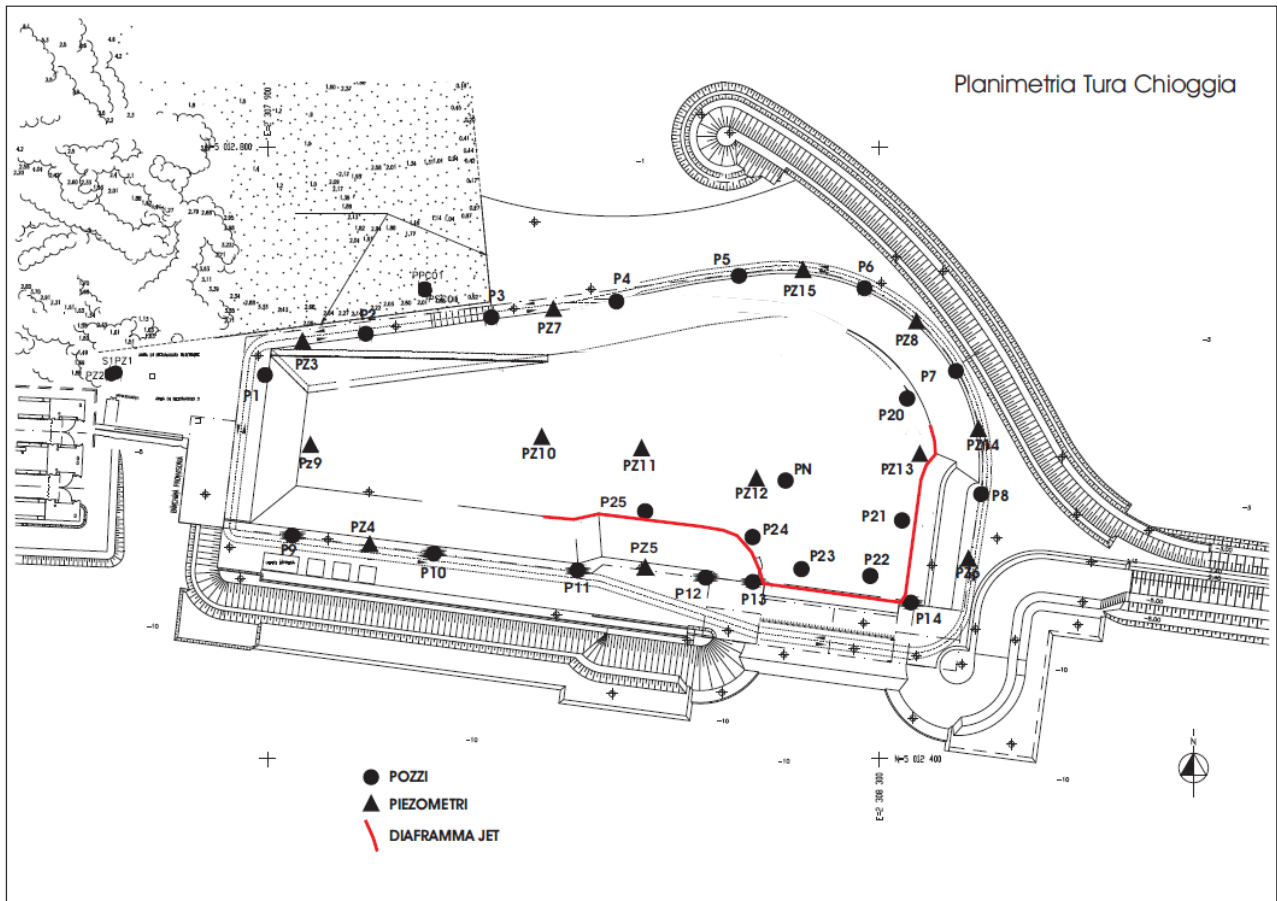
Planimetria del sistema di dewatering della tura (fonte: Consorzio Venezia Nuova).
